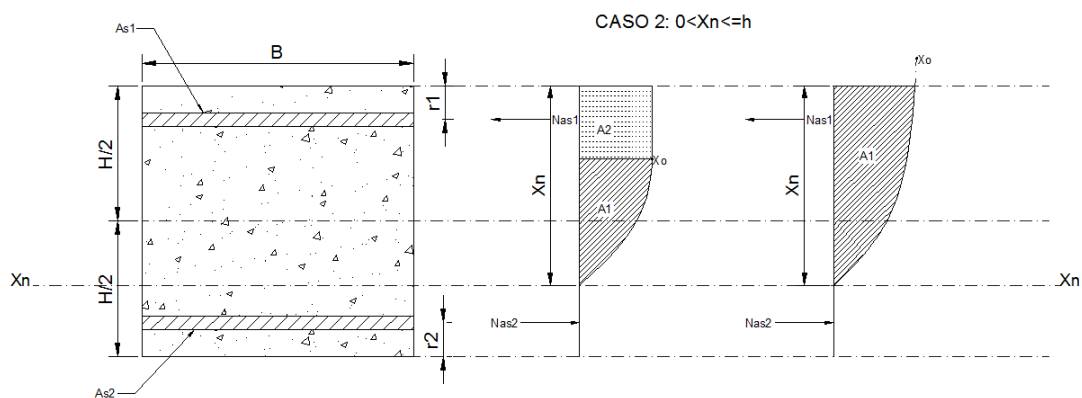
Caso 2 de distribución de esfuerzos del hormigón
